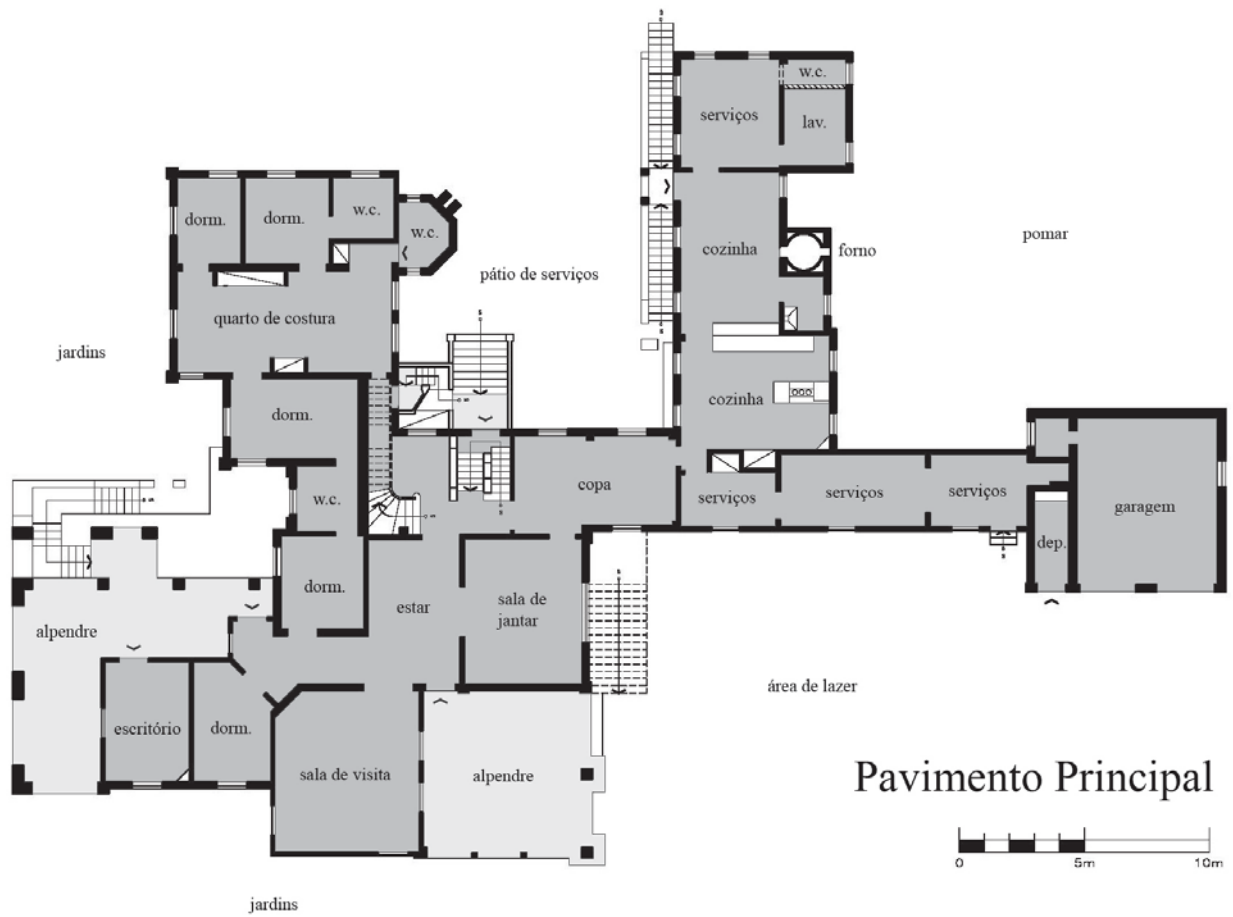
(acima) - Planta do pavimento principal. Casarão da fazenda Nossa Senhora Auxiliadora, Restinga. Lev.: V. Benincasa e L. M. M. da S. Rosa. Desenho: M. Rosada.
